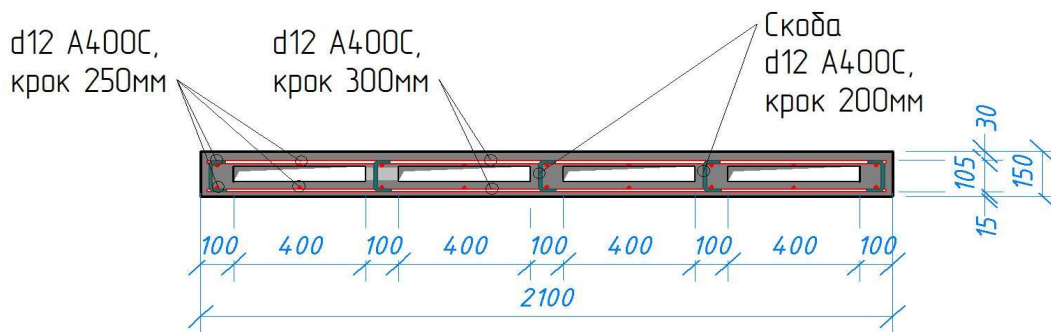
Поперечний переріз багатопорожнистої плити перекриття.
